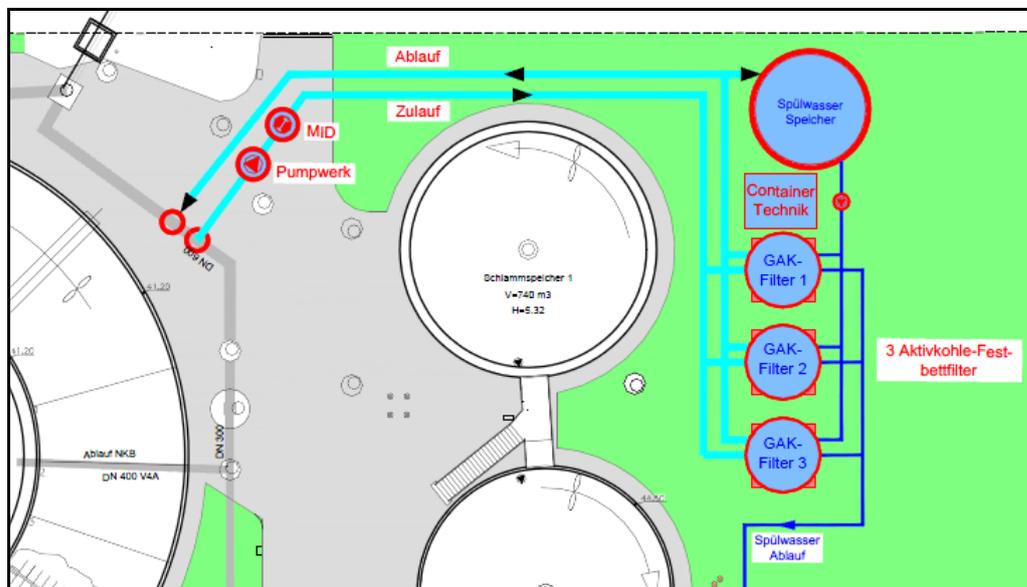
Lageplan KA Rahden - Variante 2.2 – GAK in Festbett-Adsorberstufe
